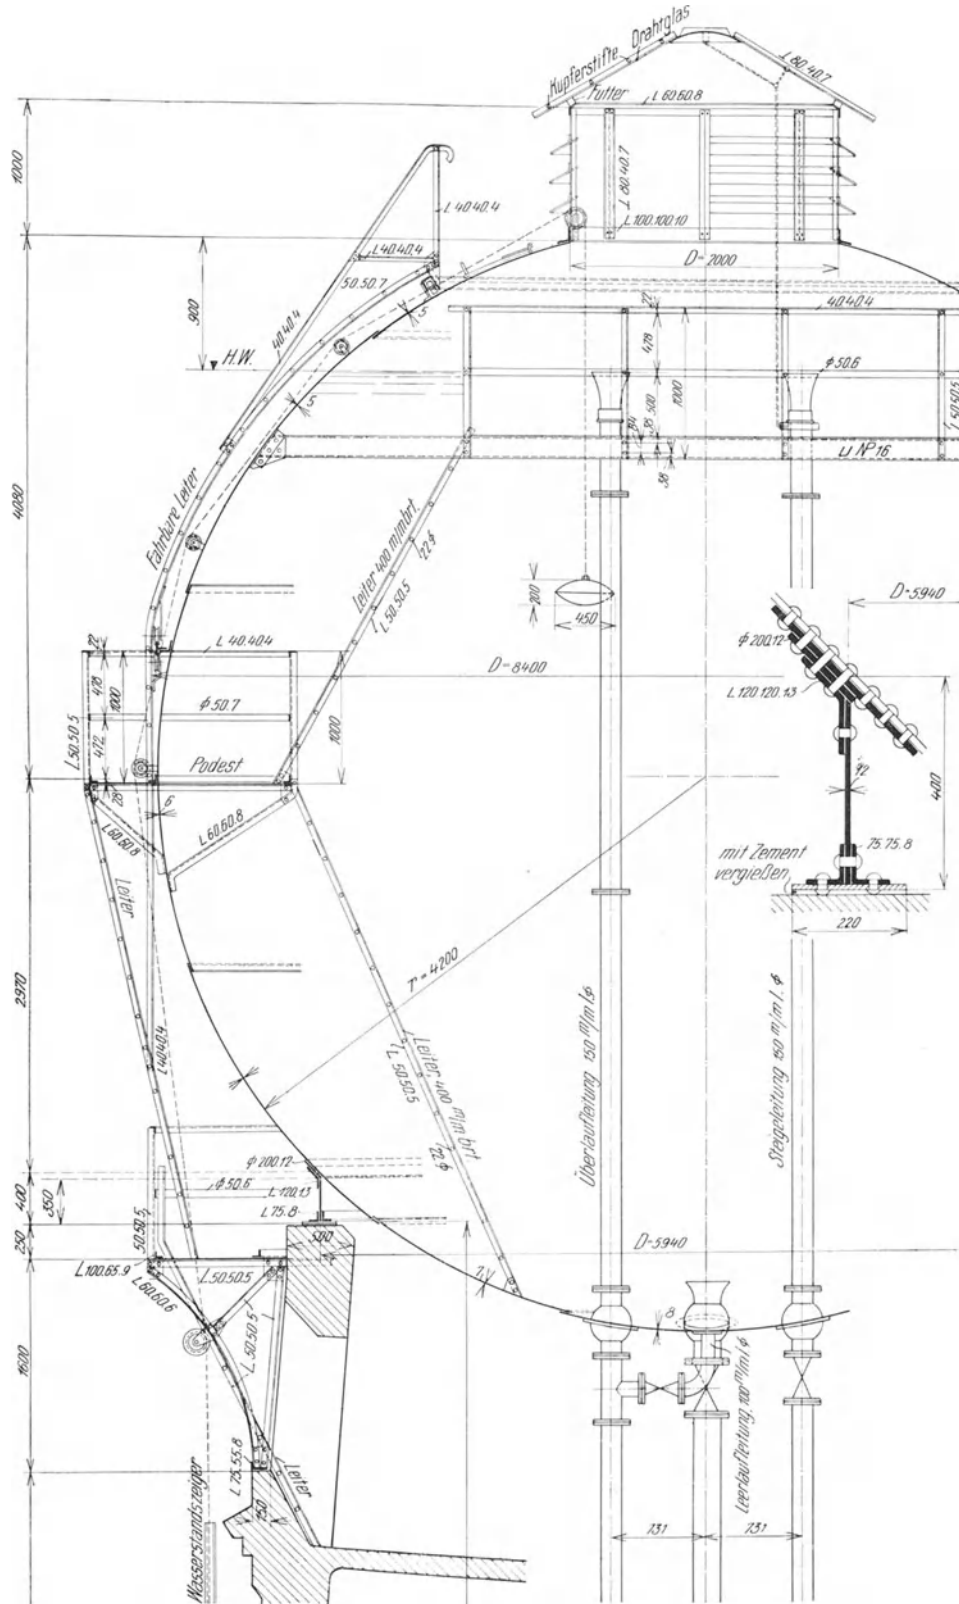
Schnitt durch einen Klönnebehälter. (A. Wilke & Co., Braunschweig)
